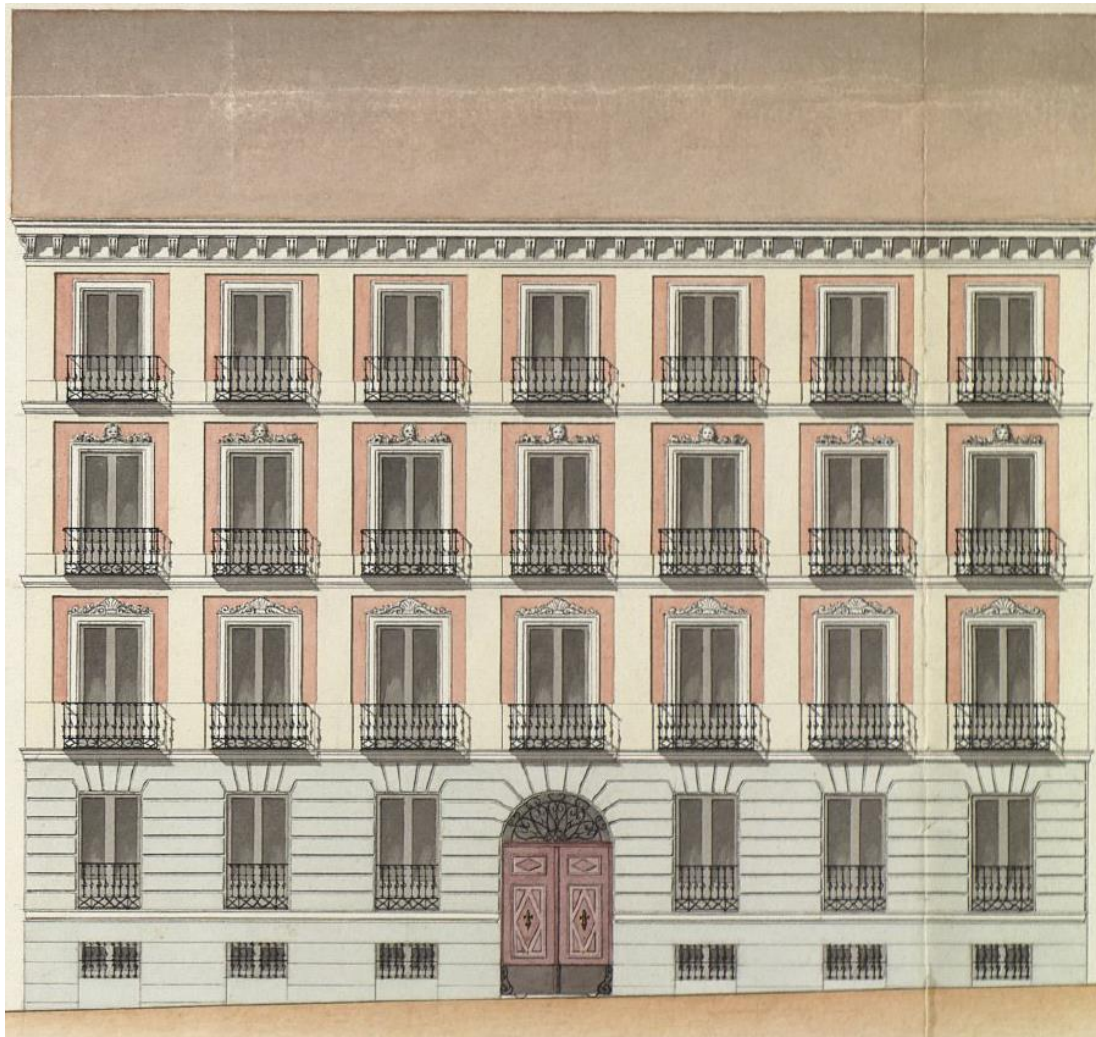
Plano de fachada del edificio según licencia concedida en 1851
